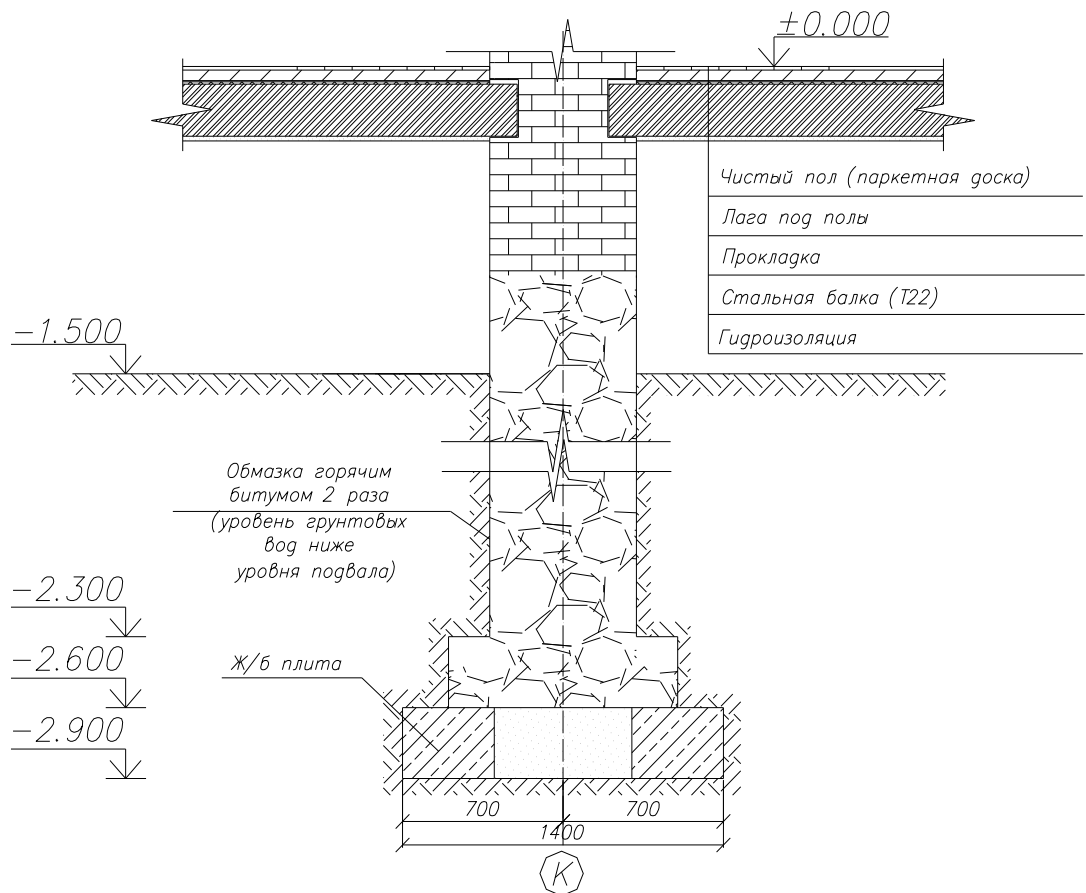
Усиление фундамента под внутреннюю стену с использованием ж\б вставок и защита стены фундамента обмазочной гидроизоляцией.
